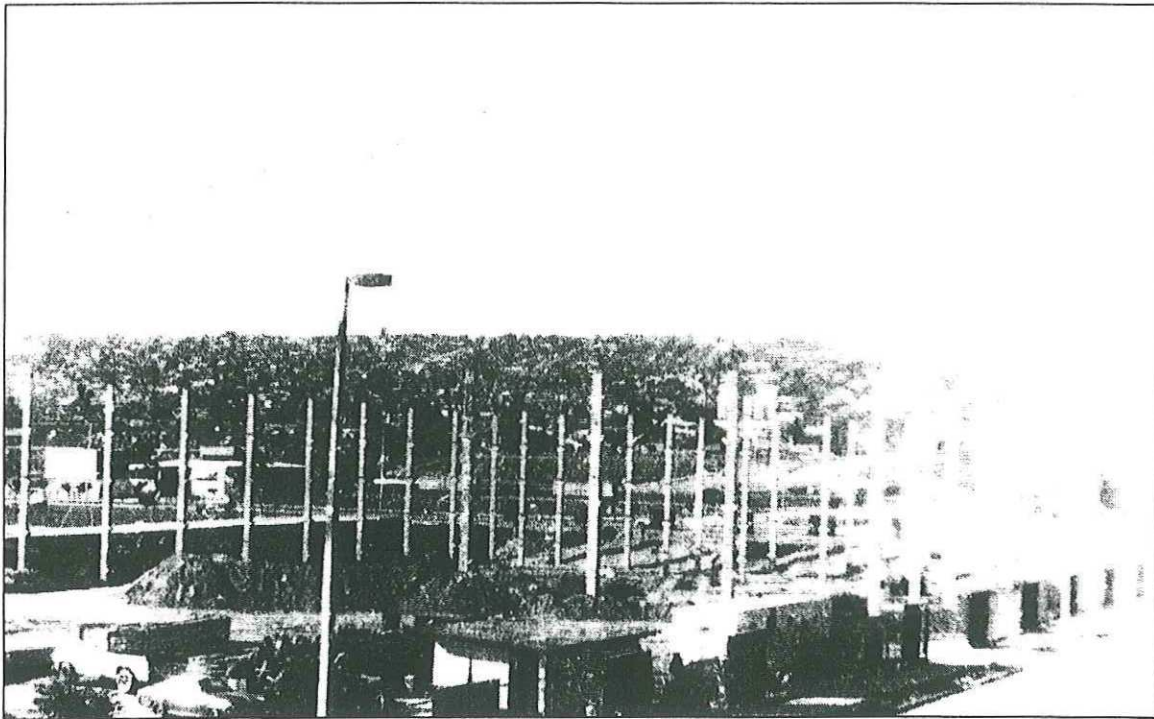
Colocación de las columnas prefabricadas (cortesía: Arq. G. Caballero).
